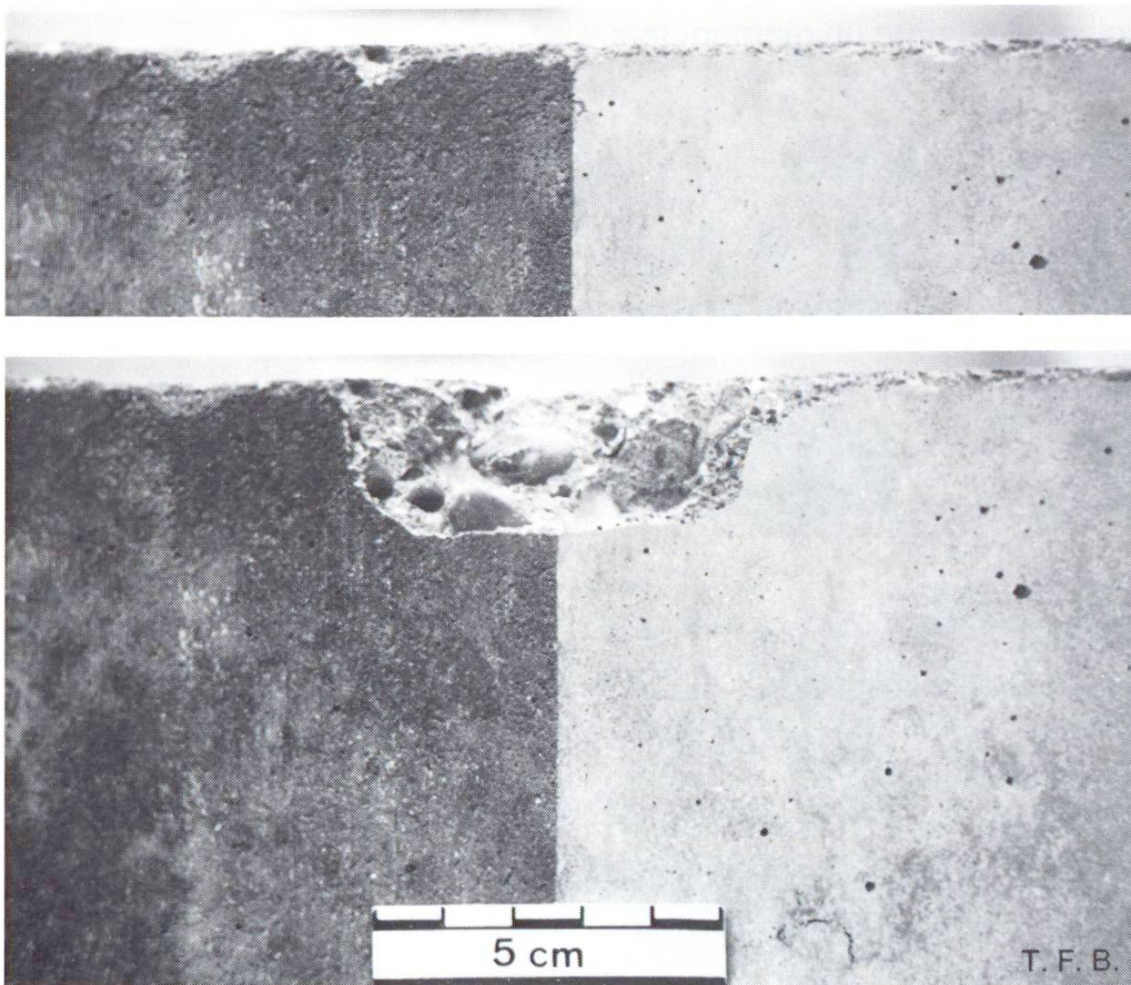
La photo montre bien la différence provoquée sur la teinte par des coffrages poreux (à gauche) et étanche (à droite). La teinte foncée ou claire ne concerne que la couche superficielle du béton.
